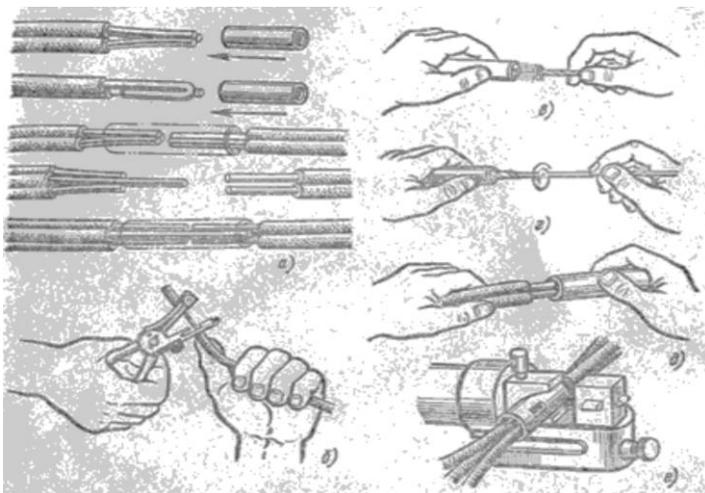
Опрессовка однопроволочных алюминиевых жил в гильзах ГАО: а — выбор гильзы; б — снятие изоляции с концов жил; в, г — зачистка и смазка внутренней поверхности гильзы; д — установка жил в гильзу; е — опрессовка.
